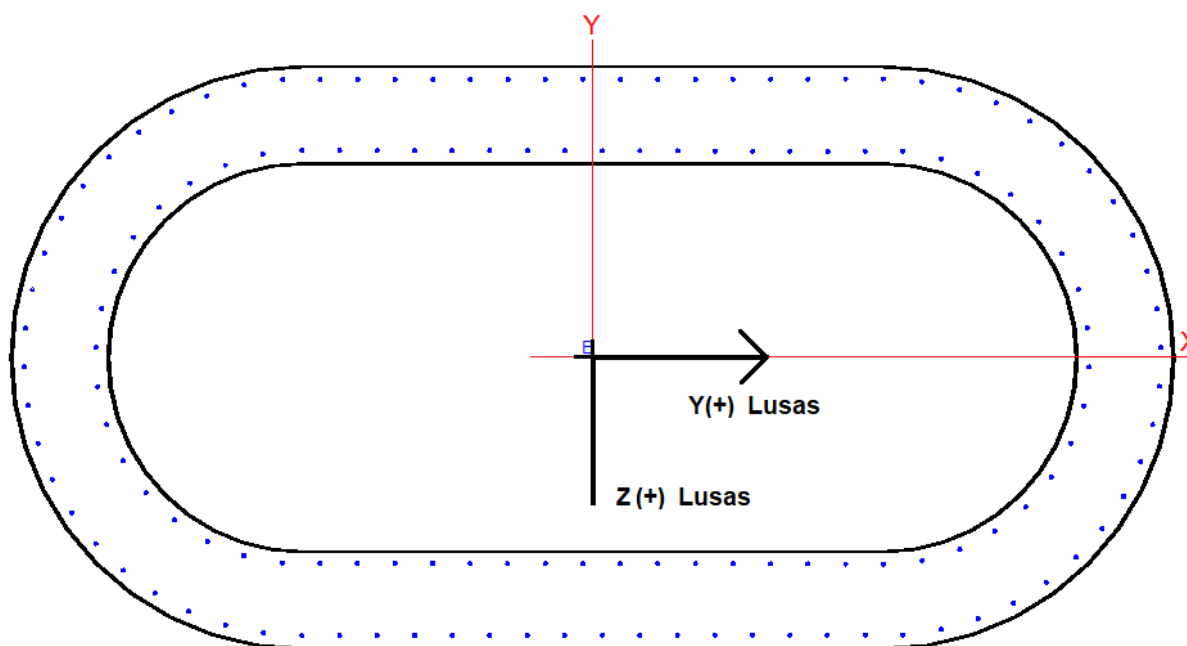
Sezione Pila Tipo - Sistema di riferimento RC-sec / LUSAS
